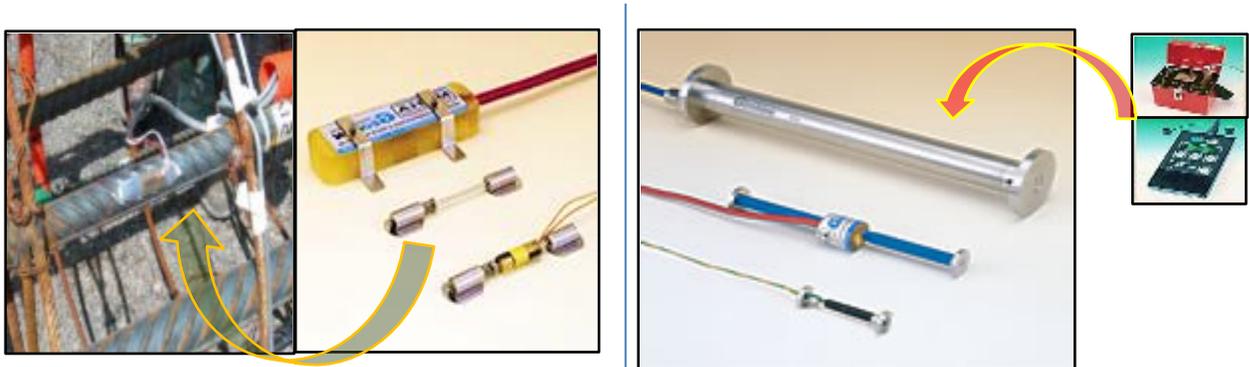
Deformímetros para acero y Deformímetro para concreto
